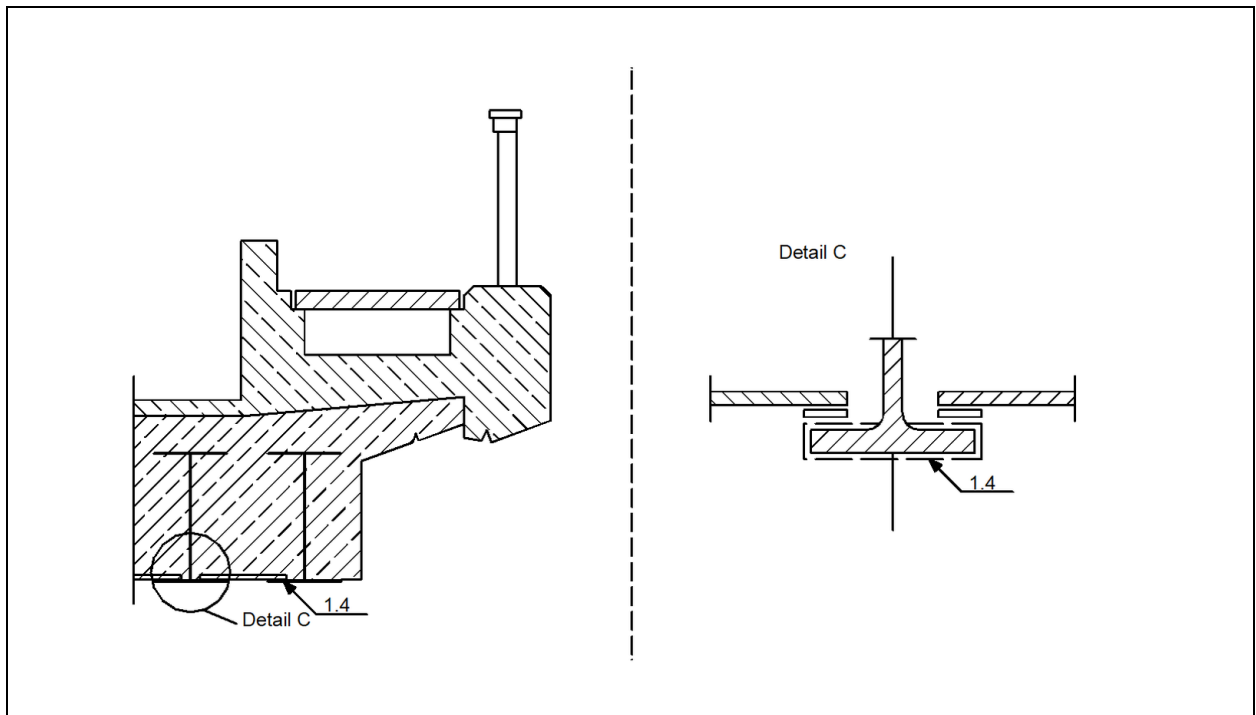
Detailquerschnitt eines Brückenüberbaus in WIB-Bauweise
